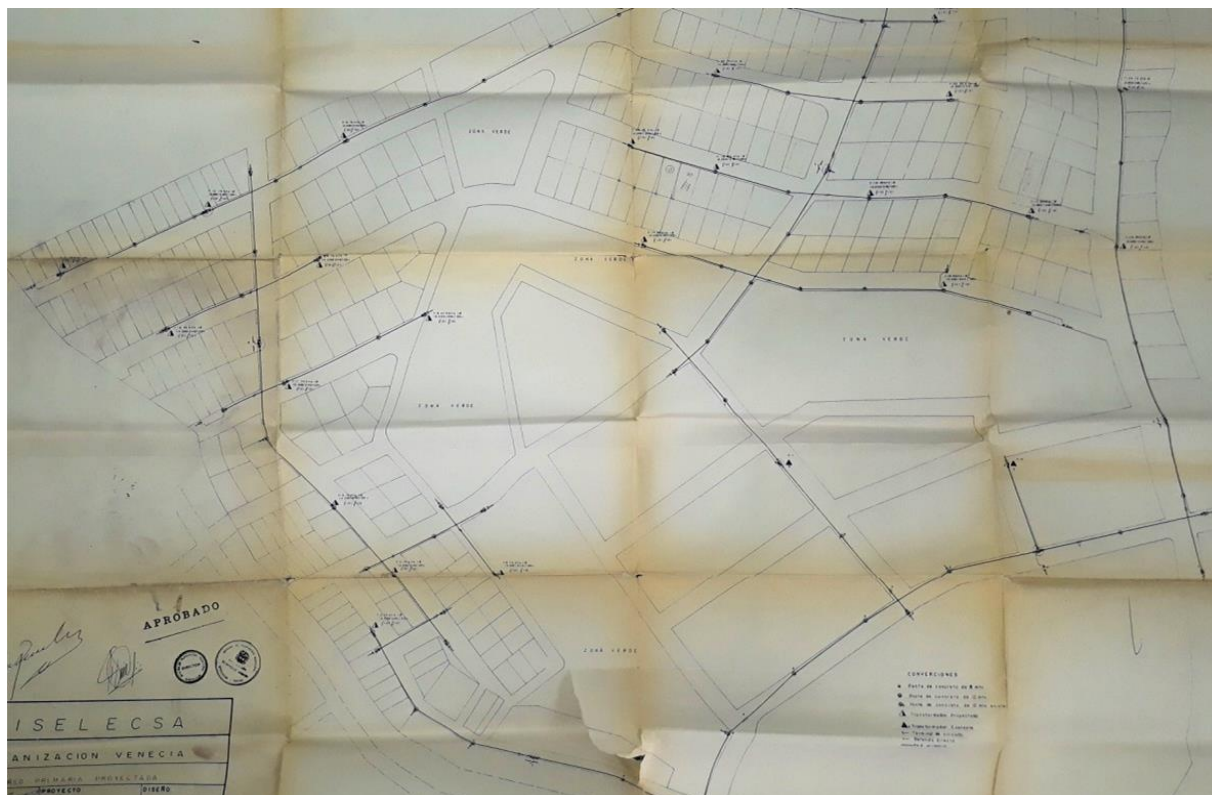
Plano red eléctrica primaria proyectada (1979) Fuente: Oficina de archivo central Sincelejo.
